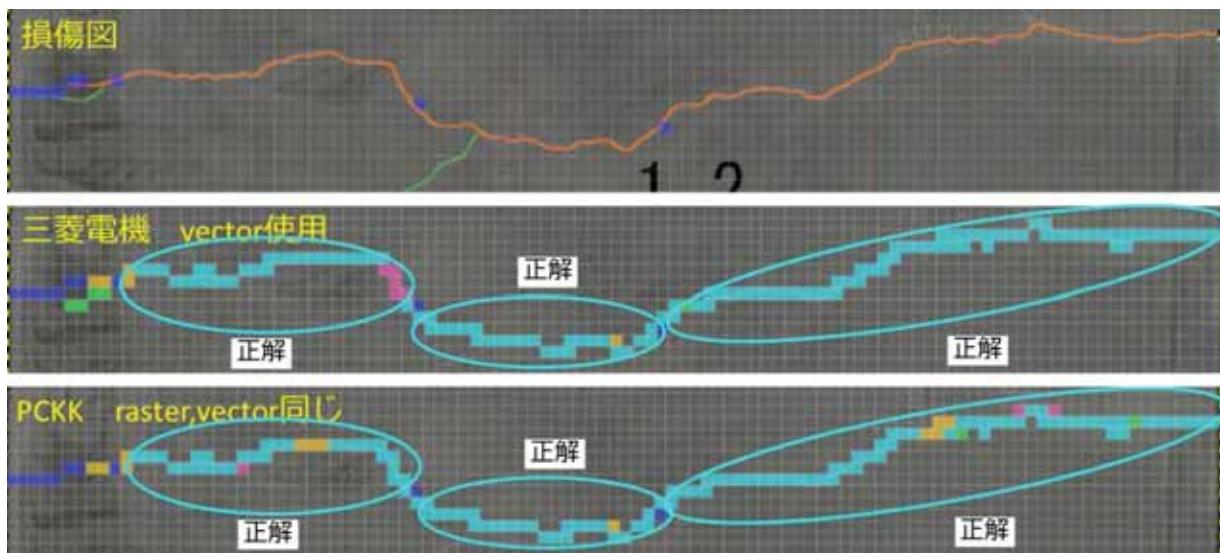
ひび割れ幅算出性能 トンネル2
